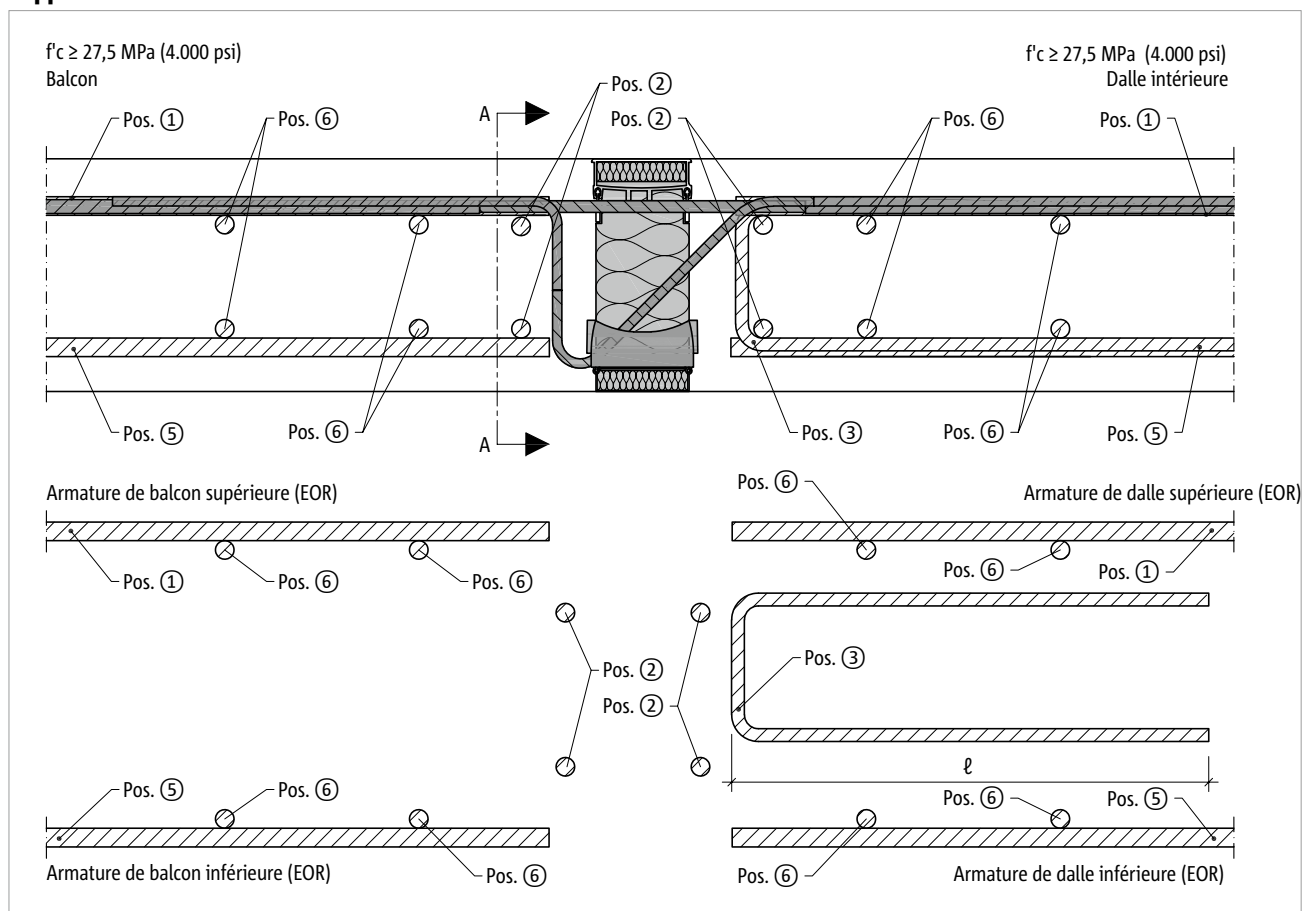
Schöck Isokorb® T Type CK : coupe transversale de l'armature recommandée pour béton coulé sur place (autre fournisseur) – support indirect
